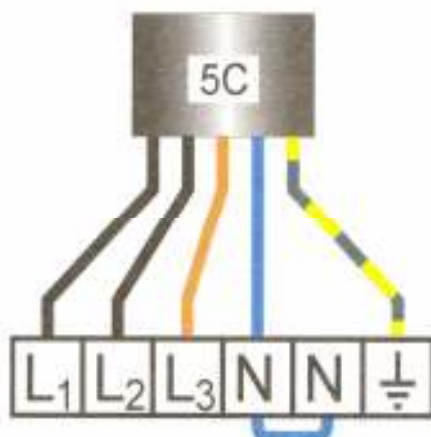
Príklad zapojenia spotrebiča v sieti TN-C
